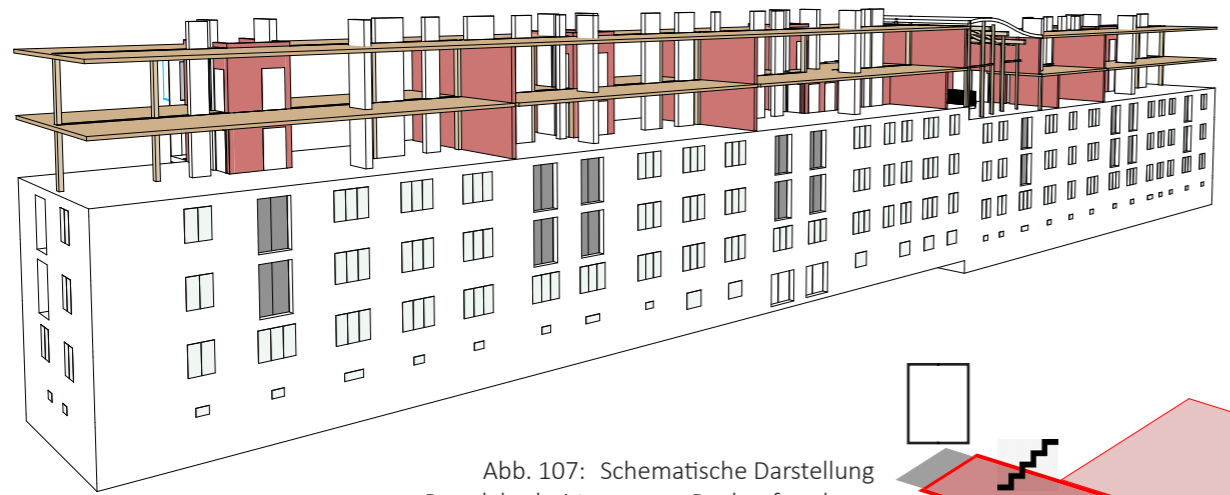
Schematische Darstellung Brandabschnitte geamte Dachaufstockung
